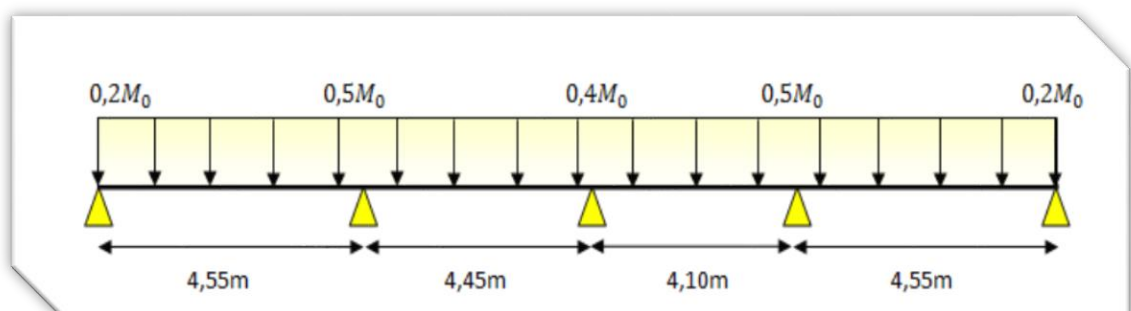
Schéma statique plancher de 10^{ème} étage (terrasse accessible).
